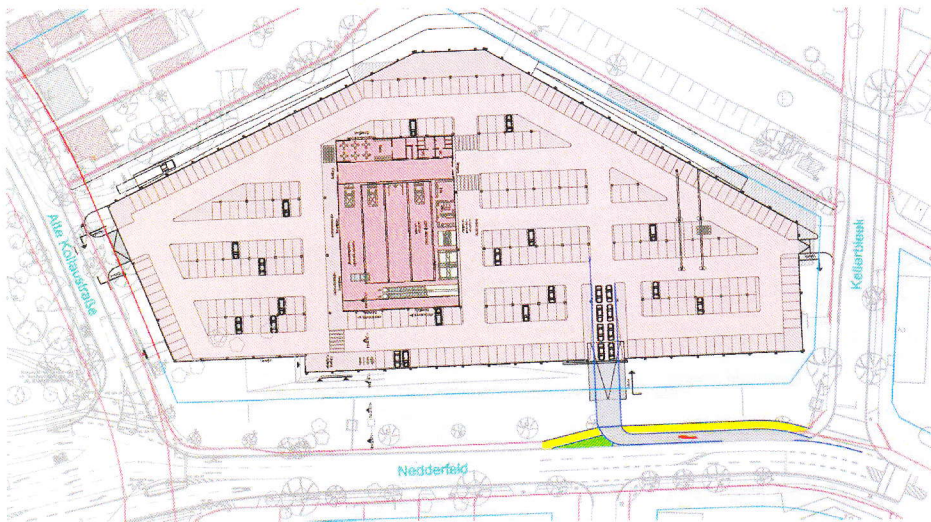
geplante Erschließung BAUHAUS-Markt;
